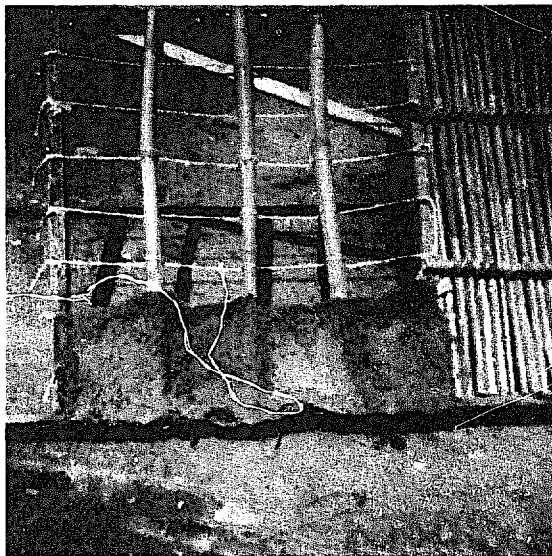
Auf der Unterkonstruktion aus Hühnermaschendraht: erste Schicht aus Pajónbündeln. Jede Schicht erhielt einen Bitumenemulsionsanstrich zur Wasserabdichtung, ehe die neue Schicht daraufgelegt wurde.
